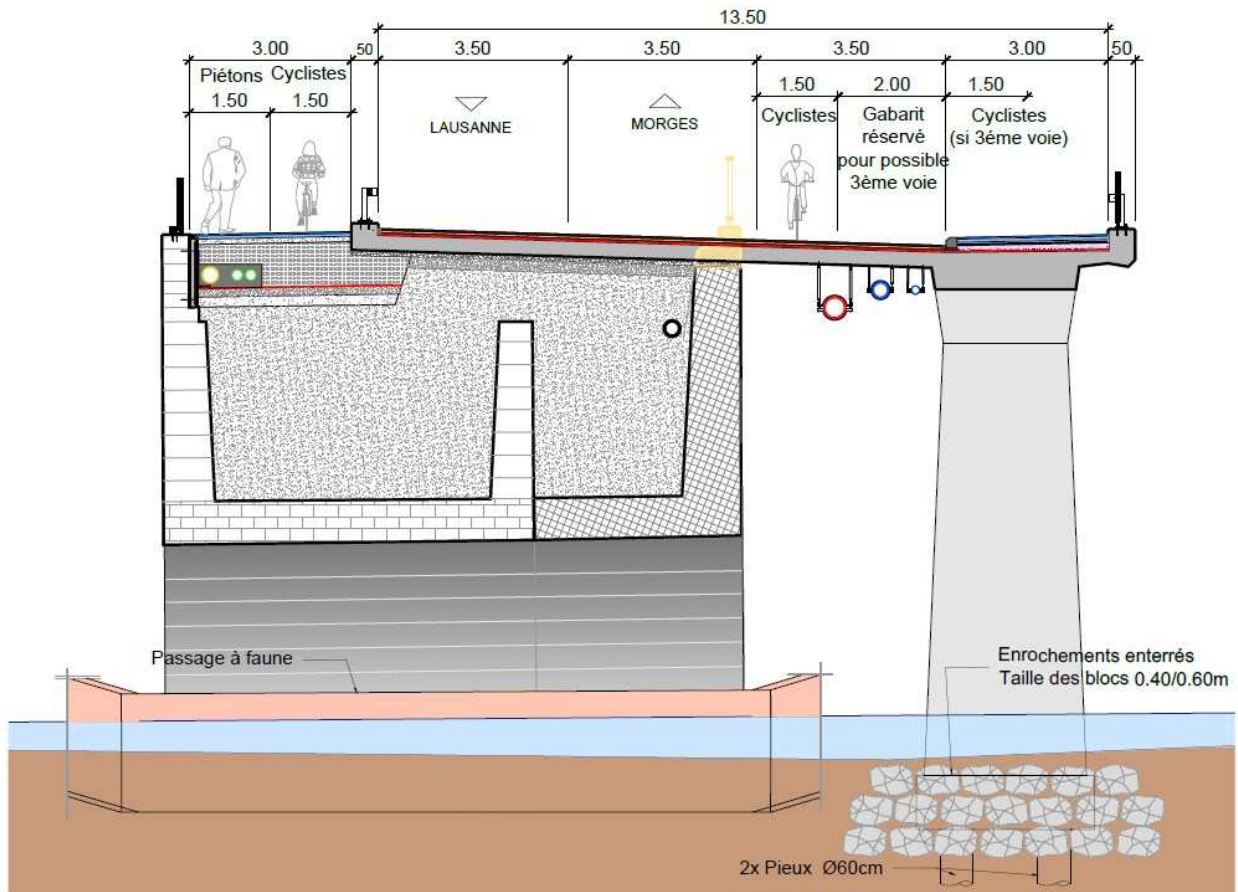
élargissement du pont sur la Venoge (profil en travers).
